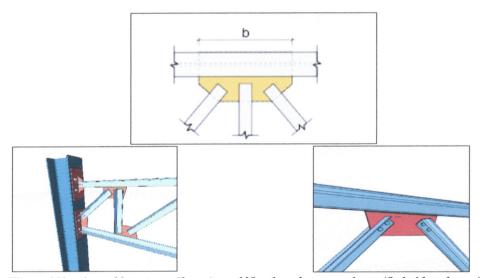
Assemblage truss (ferme) soudé/boulonné source : https://help.idecad.com/
